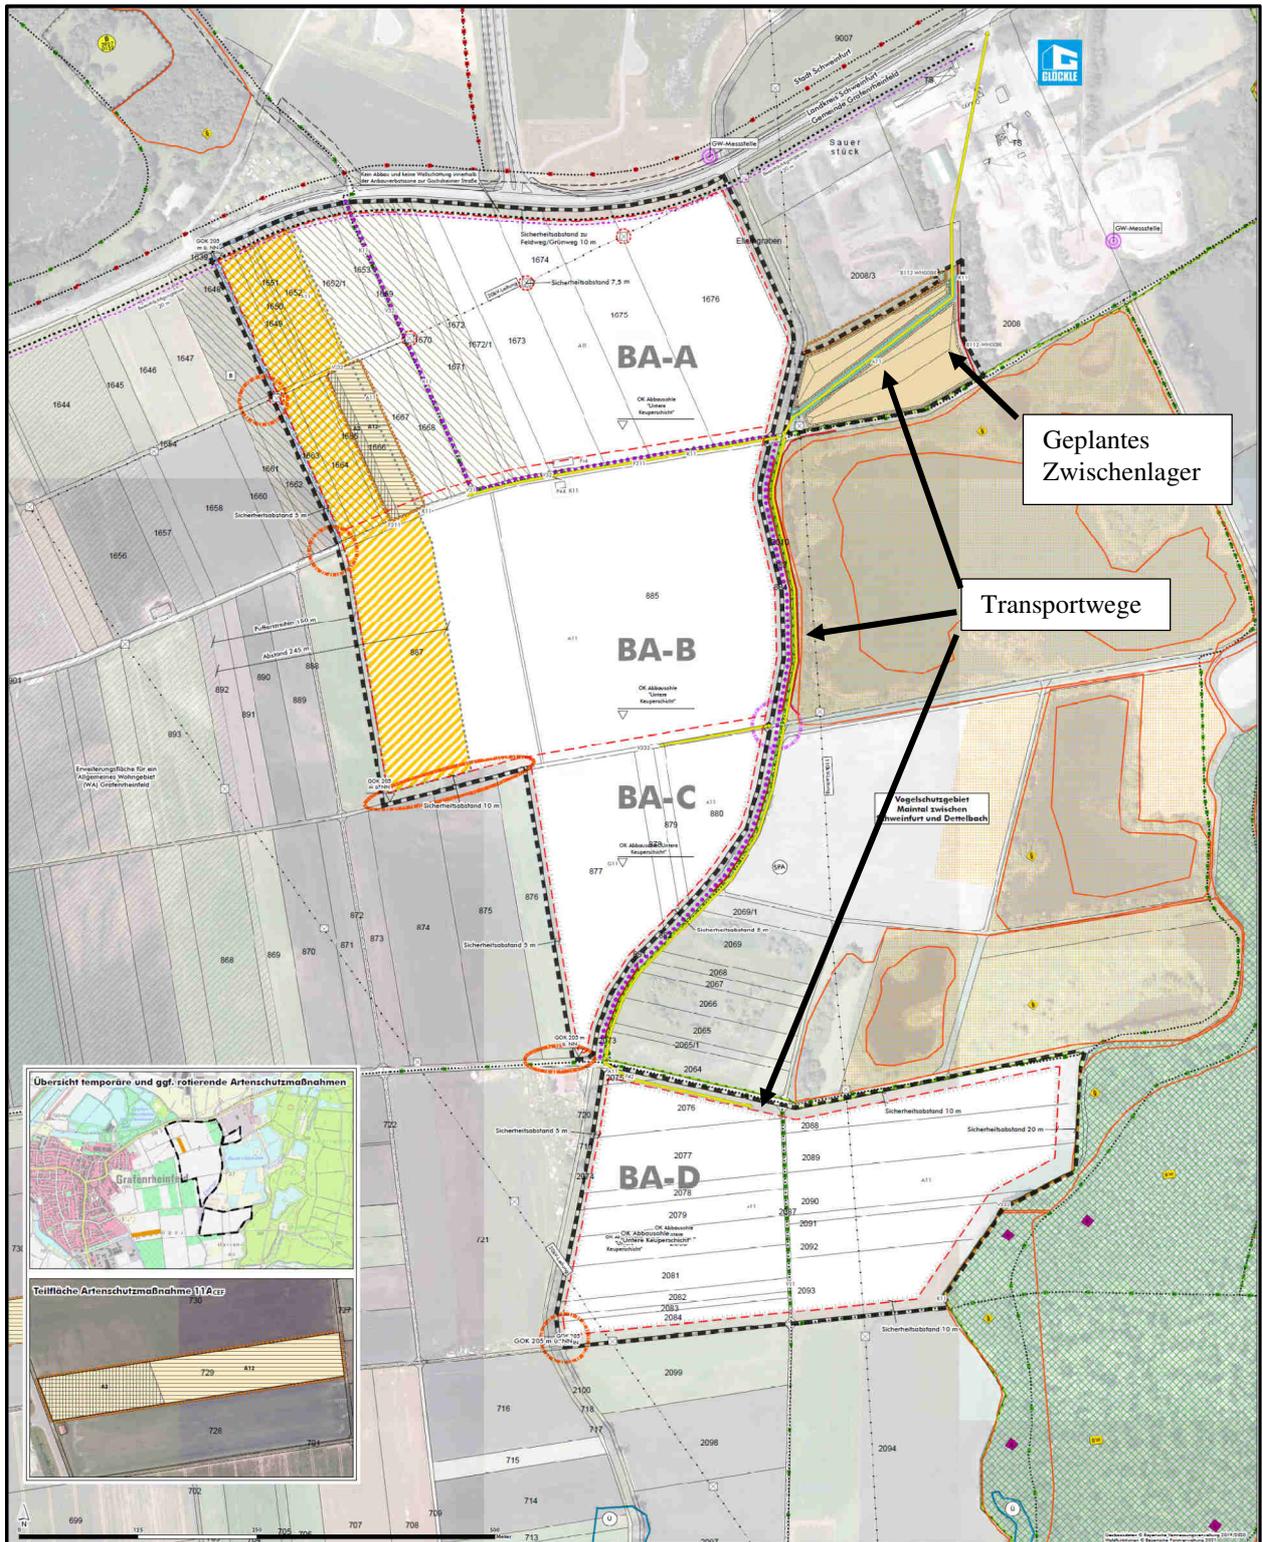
Planausschnitt mit den vier Bauabschnitten und geplanten Transportwegen (Quelle: Glöckle GmbH/ arc.grün|landschaftsarchitekten.stadtplaner.gmbh)
